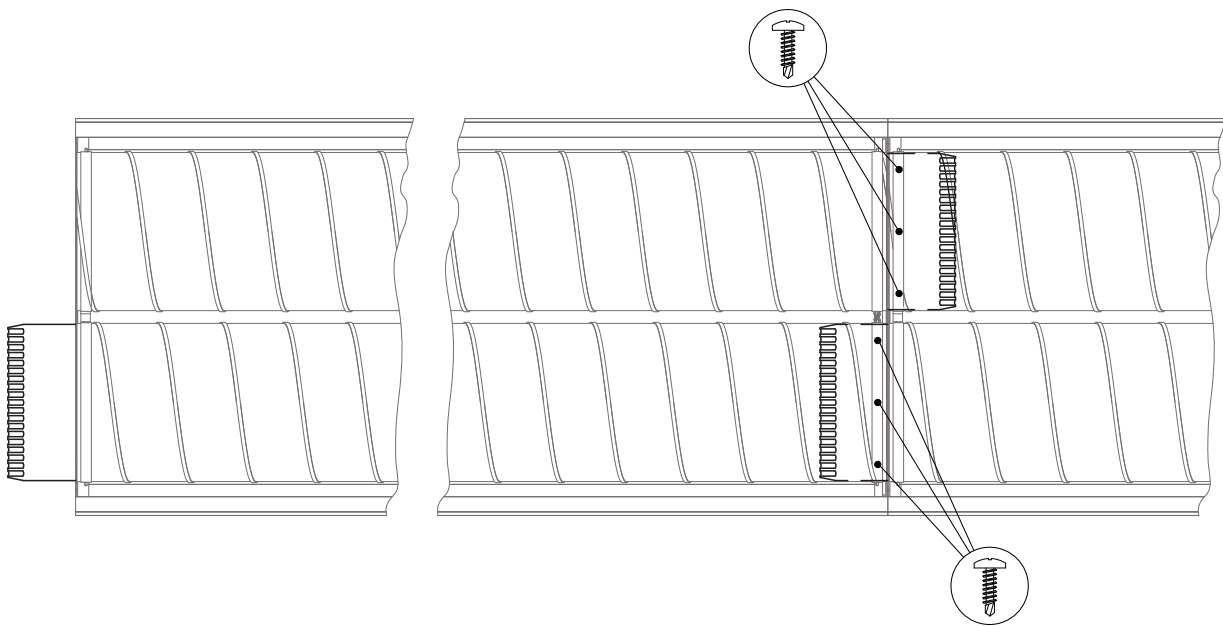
Blocage manchon-tube (vue de dessous)
